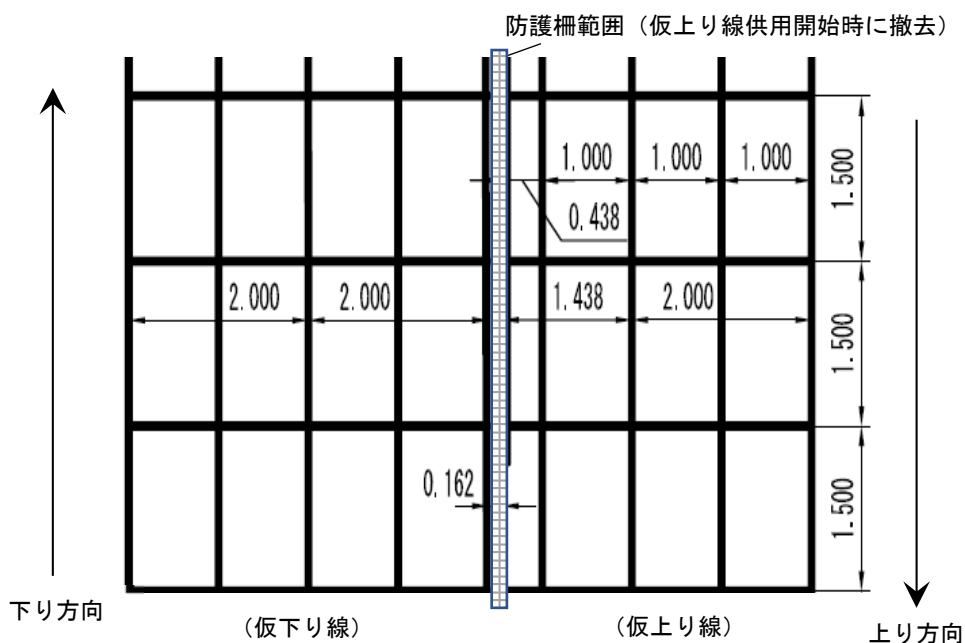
格子状補強シートの配置 (平面図、単位：mm)
